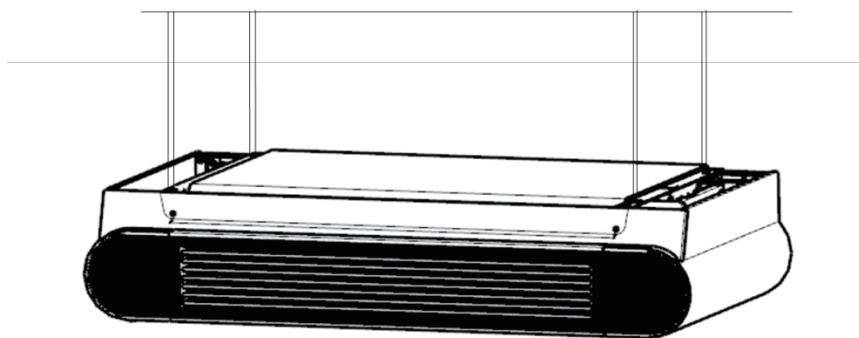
Schéma d'une installation au plafond avec unité apparente
